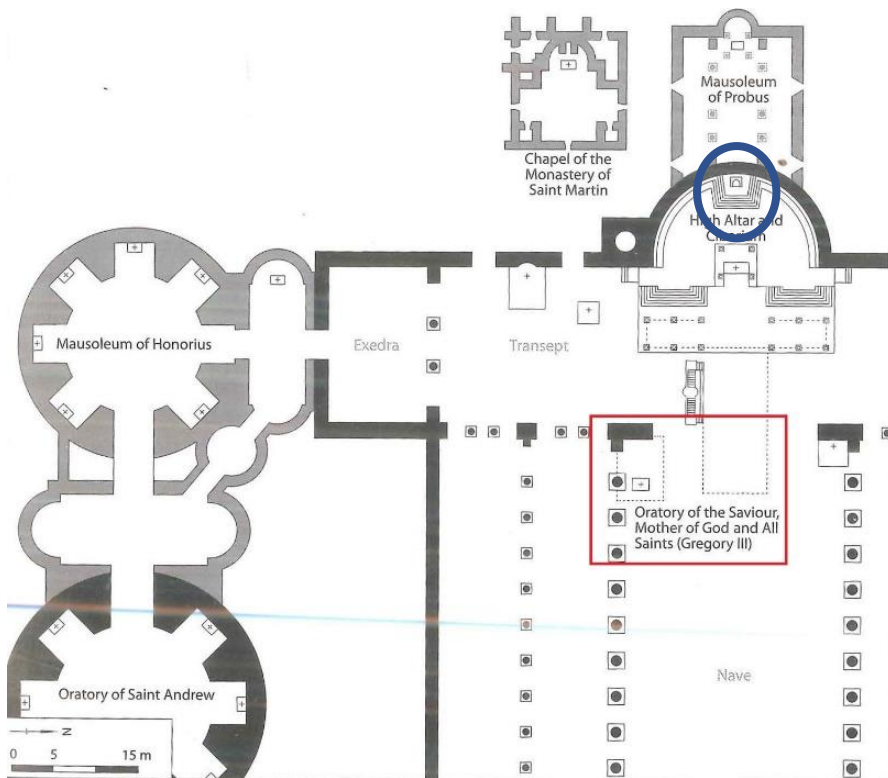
Dettaglio della planimetria di S. Pietro (Thacker 2013).
